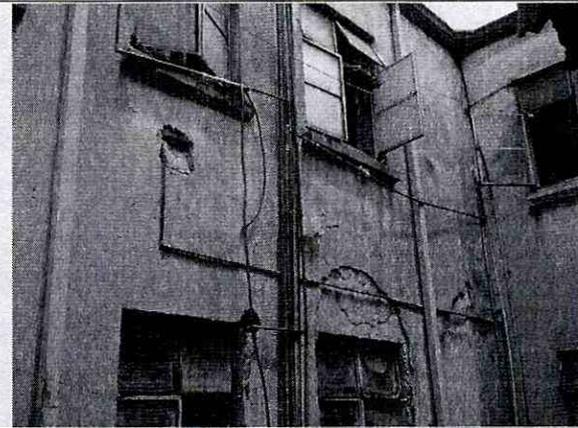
Aspecto general muros fachadas internas. Pérdida de revoque (pañete)
